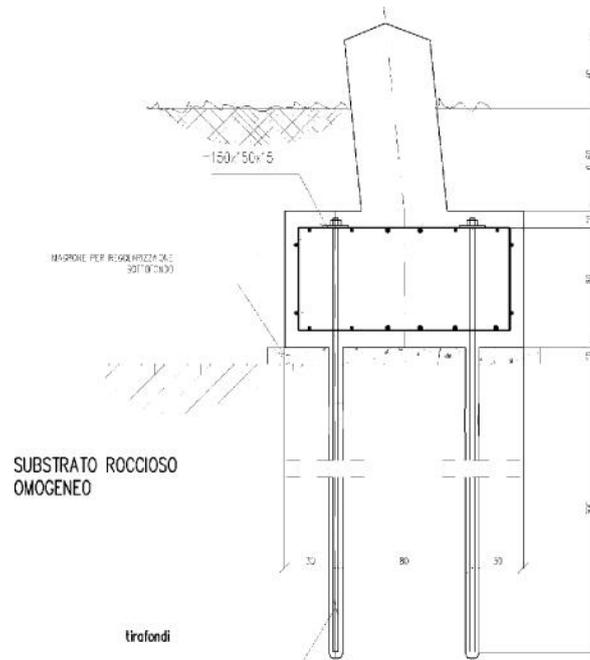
Esempio di fondazione con tiranti in roccia
